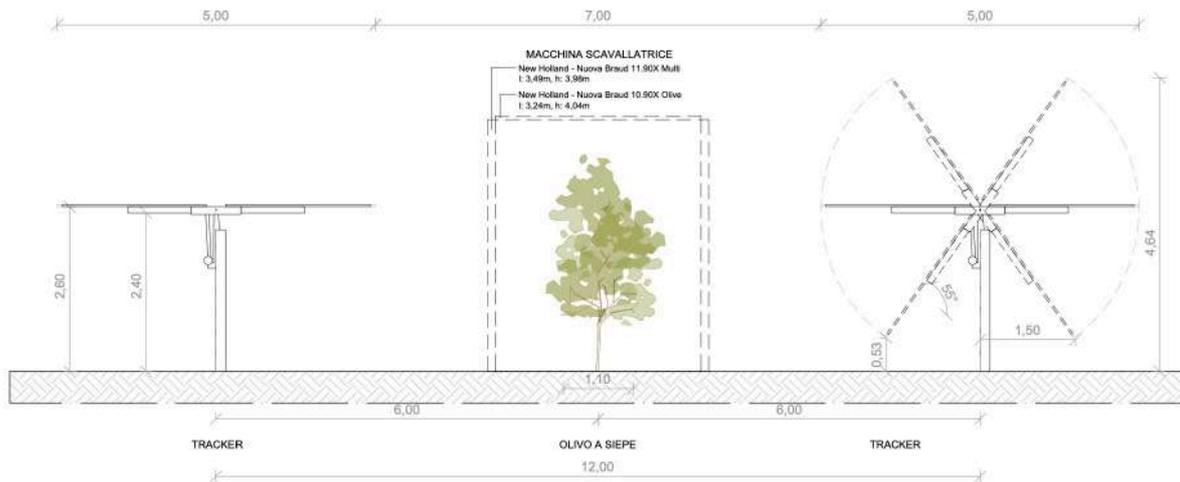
Sezione tipo dell'impianto impianto agrivoltaico
